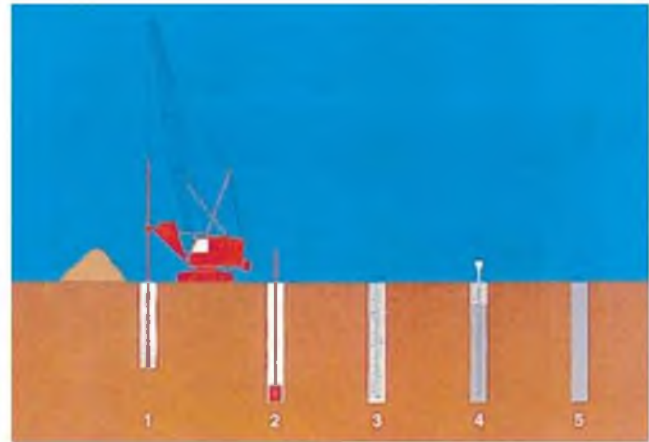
Proceso constructivo de pilotes hormigonados *in situ* a rotación en seco. 1) Perforación con hélice o cazo en orificio estable. 2) Limpieza del fondo con cazo, si procede. 3) Colocación de la armadura. 4) Hormigonado con tubo «tremie». 5) Pilote terminado.
